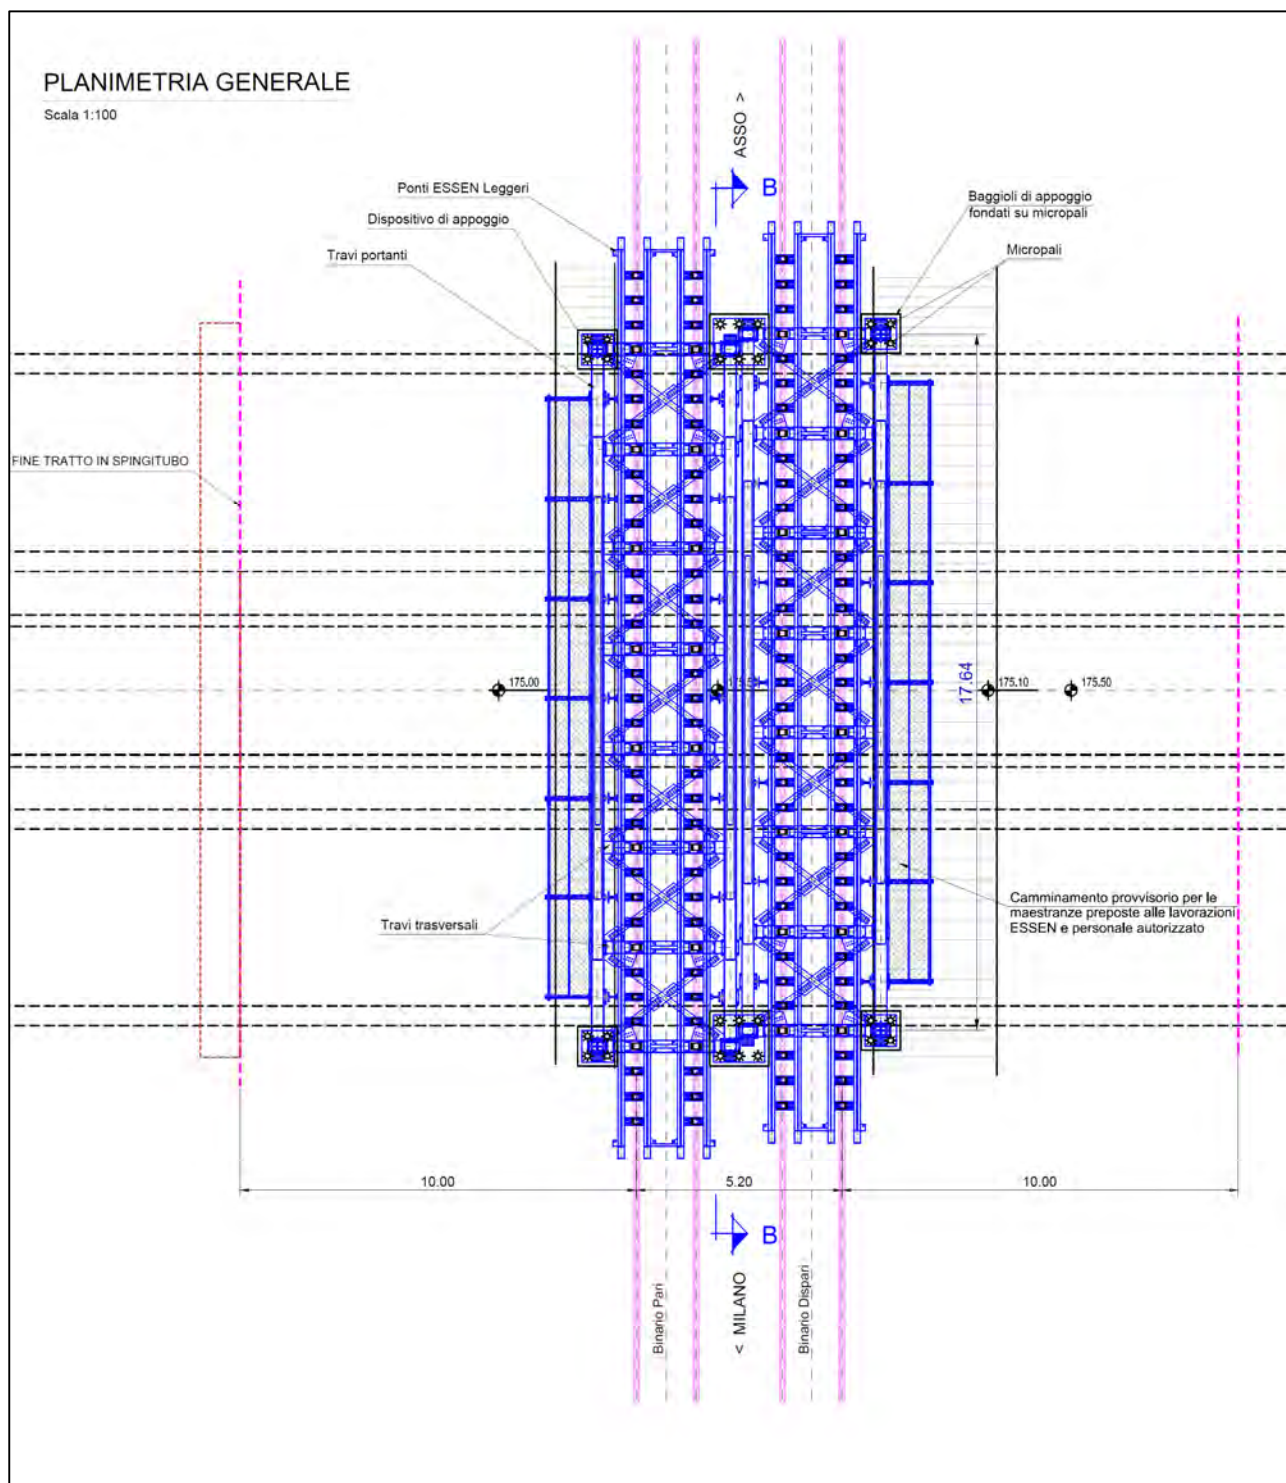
Planimetria generale intervento di sostegno con ponte gemellato Essen
